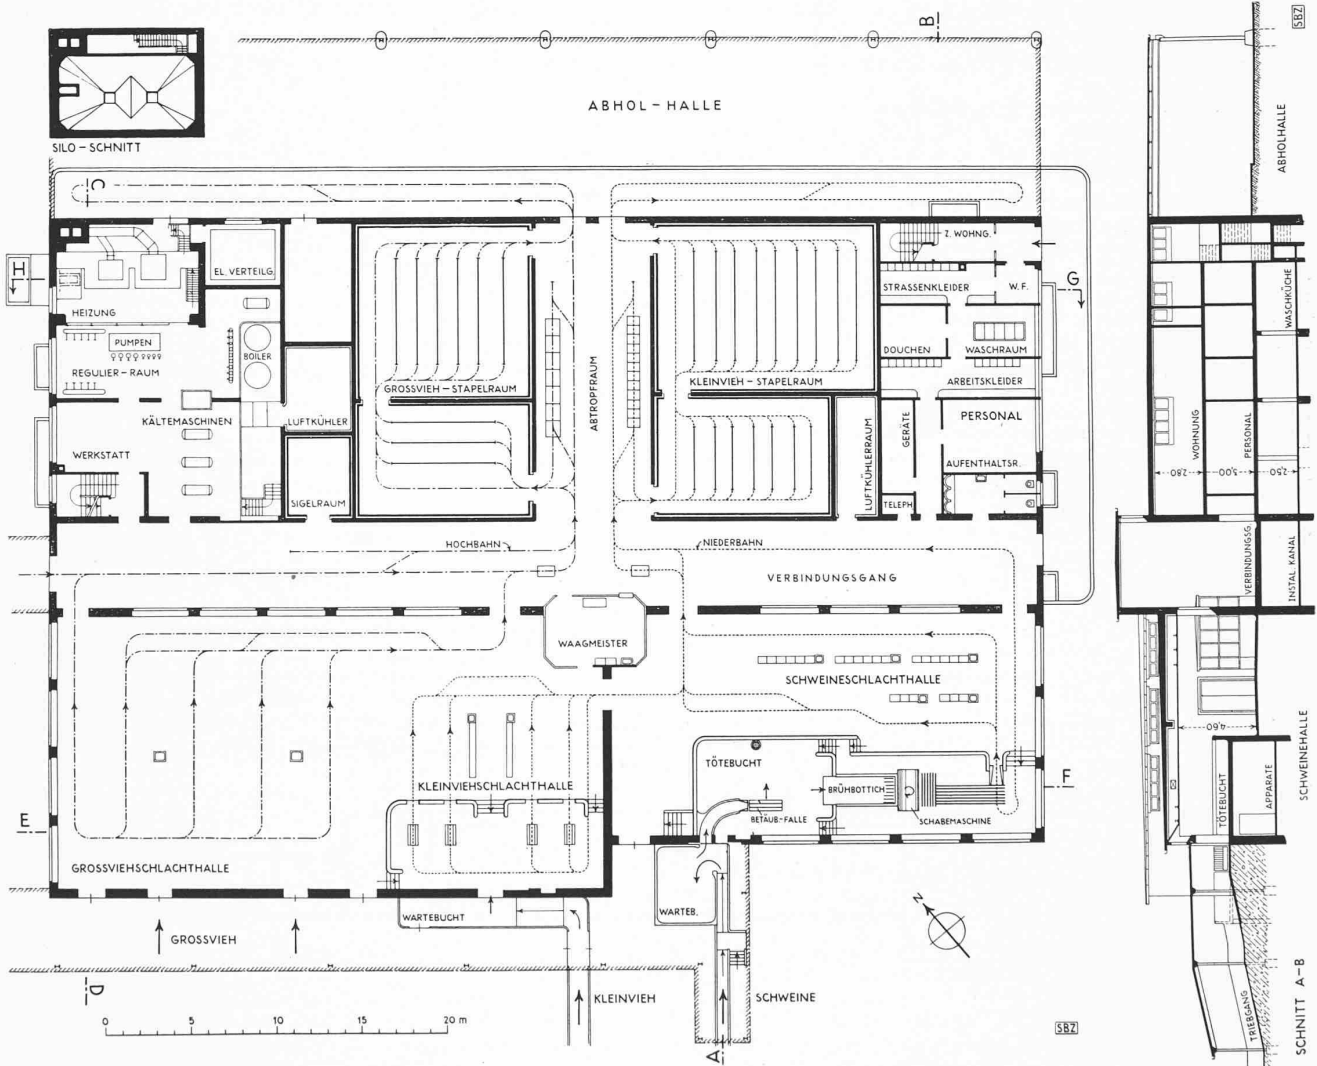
Grundriss und Abb. 5 und 6 Schnitte des Schlachthauses Nägelsee-Winterthur
